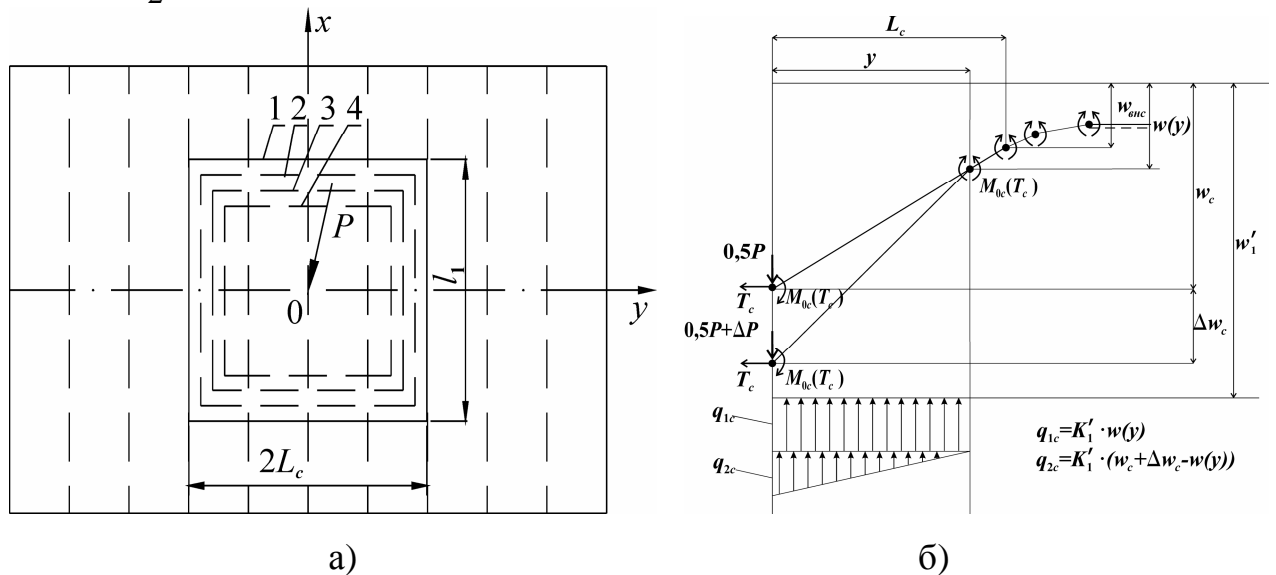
Расчёт локально загруженного стрингера: а) – схема обрушения бортового перекрытия; б) – схема деформирования обрушившегося звена стрингера и распределения реакций основания в первой стадии деформирования
